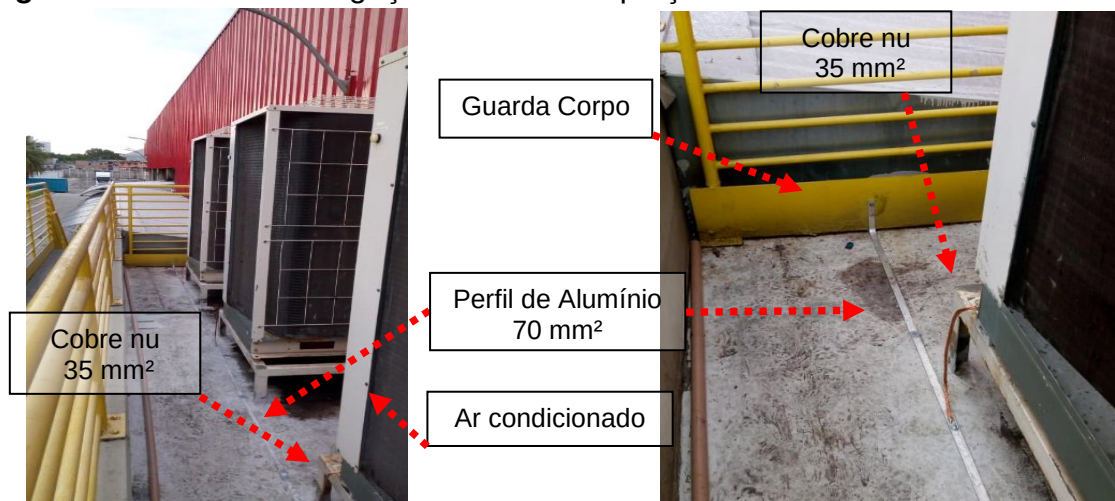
e 117: interligação malha de captação com estruturas metálicas.
